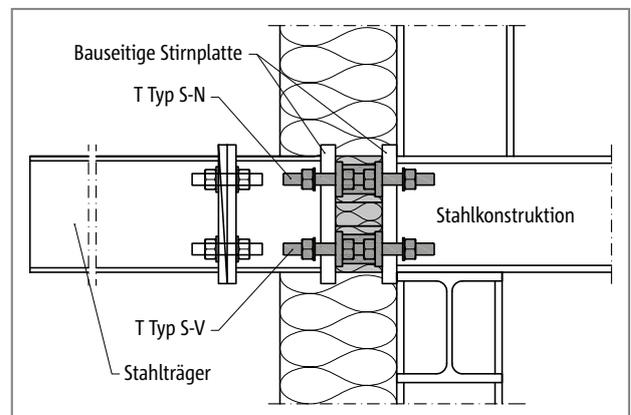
Schöck Isokorb® T Typ S: Stahlkonstruktion frei auskragend; Adapter bauseitig
